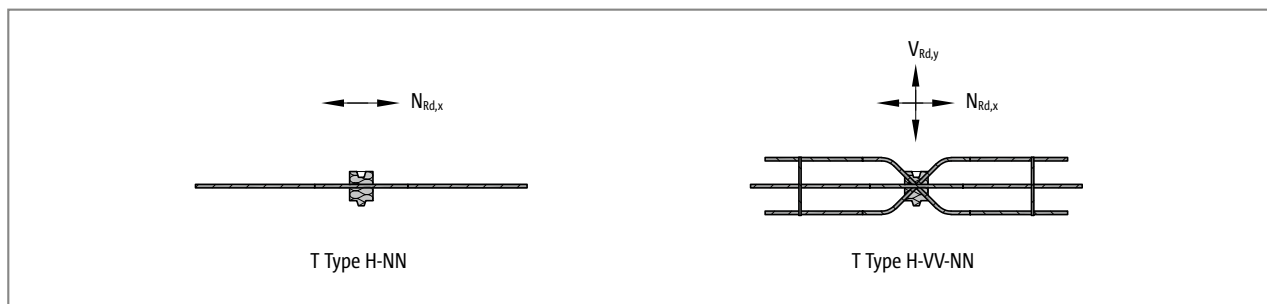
Schöck Isokorb® T Type H : Sélection du type
